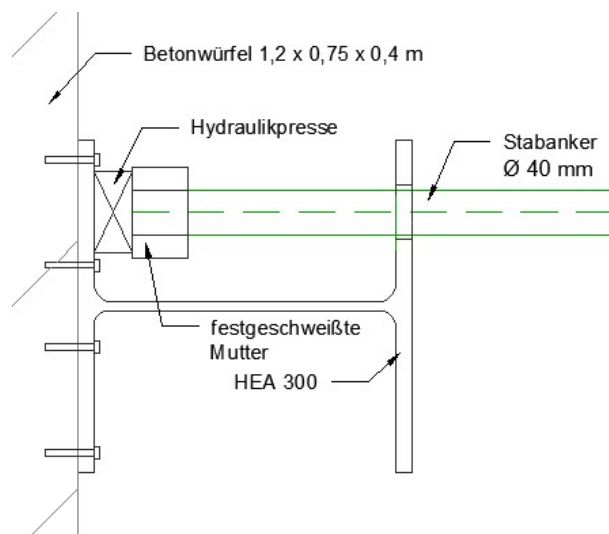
Detail Anschluss Stab an Betonwiderlager Variante 2
